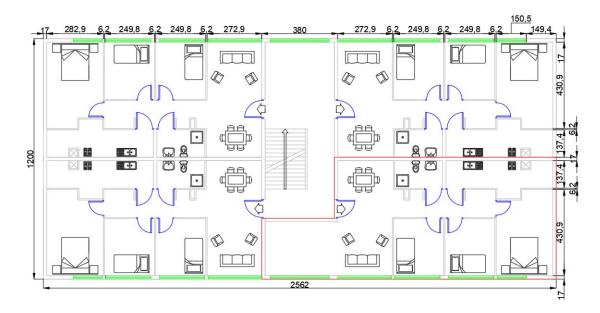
Planta arquitectura sector D2, 4 departamentos por planta, Villa Jaime Eyzaguirre replicada en AutoCAD. Fuente: Elaboración propia.
